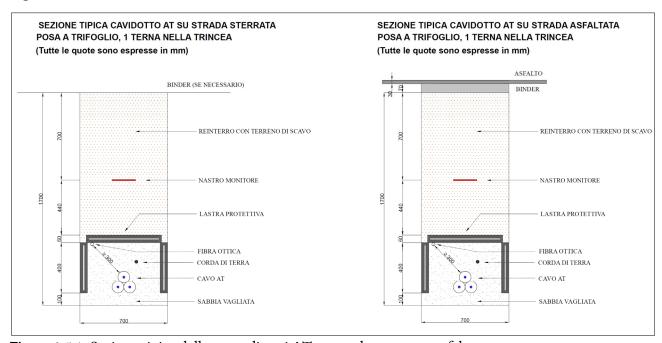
Sezione tipica della terna di cavi AT su strada sterrata e asfaltata
